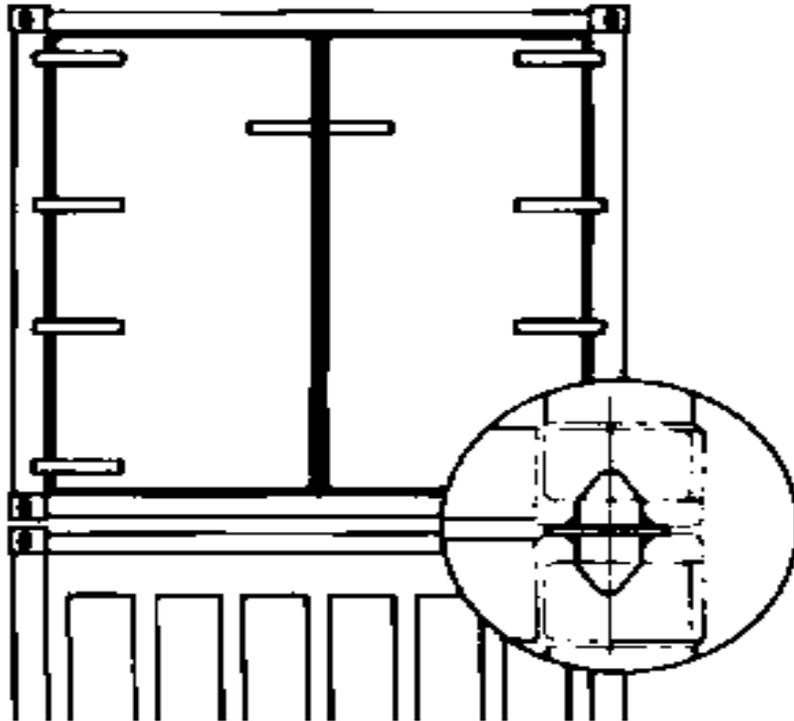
Detalle cono de apilamiento. The Standard. 2012.
